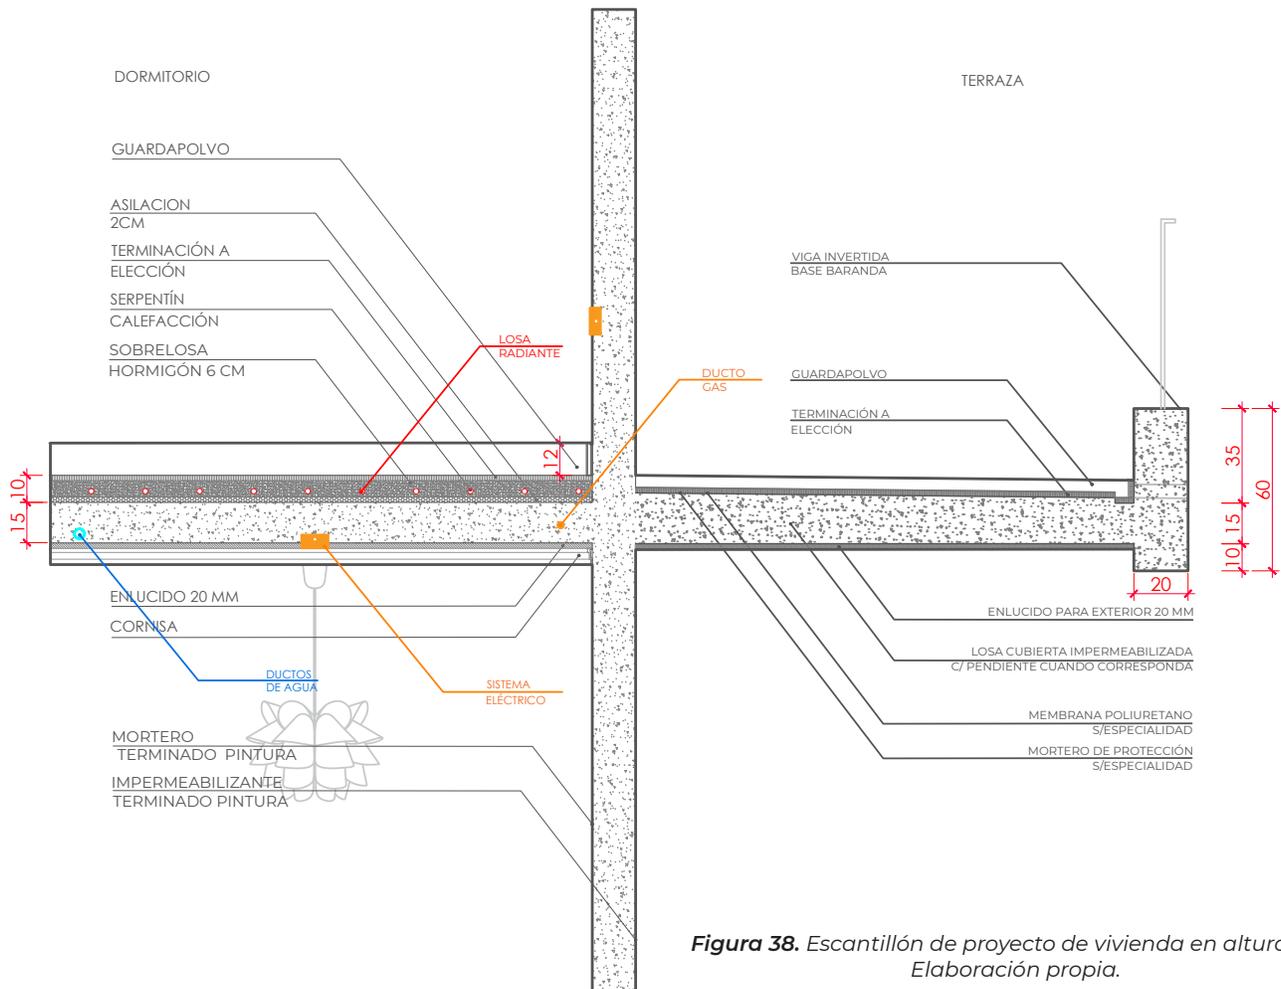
Escantillón de proyecto de vivienda en altura tipo. Elaboración propia.
